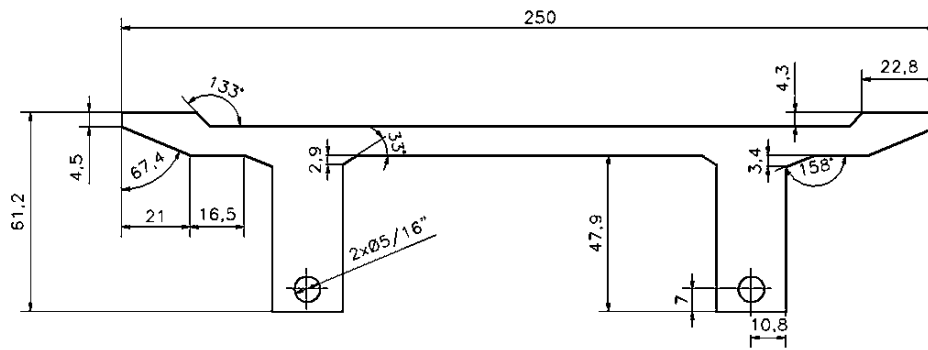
Sección transversal de un puente con voladizos laterales.
